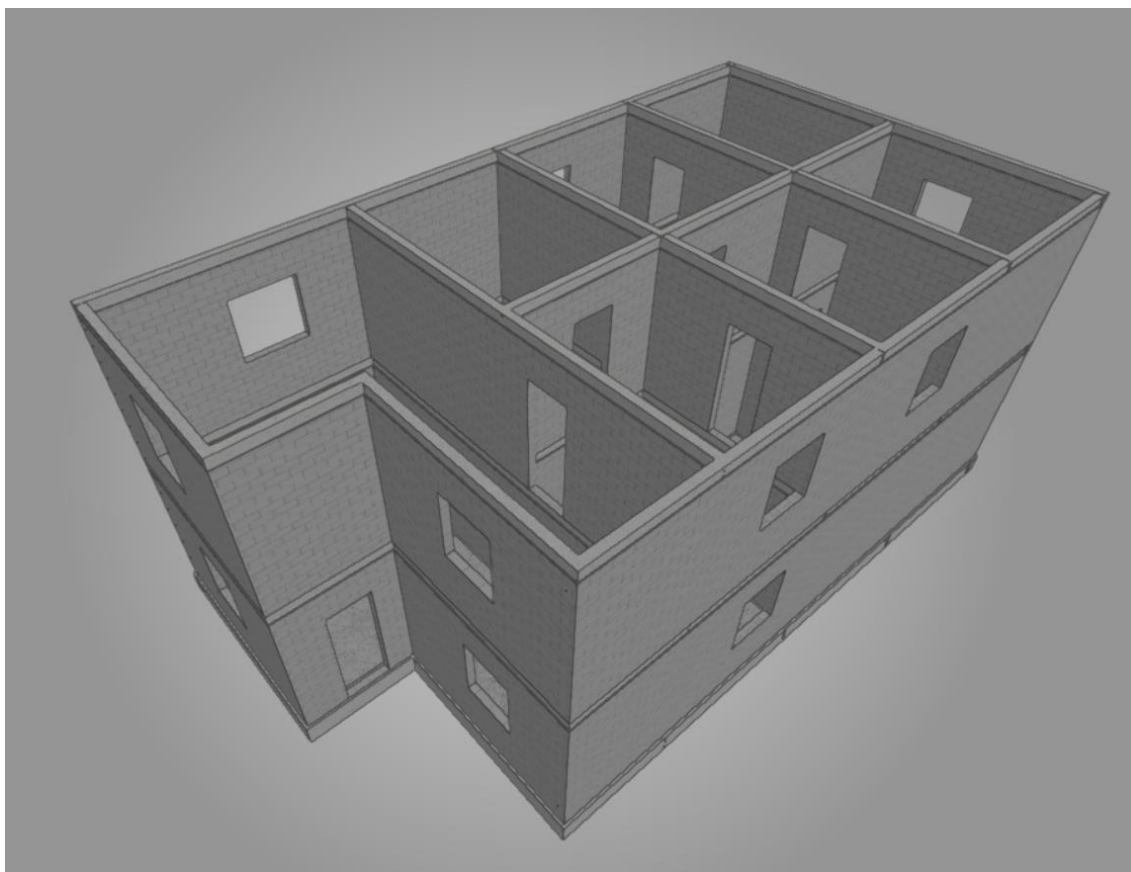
Distribución de muros de planta alta - Fuente: elaboración propia.
